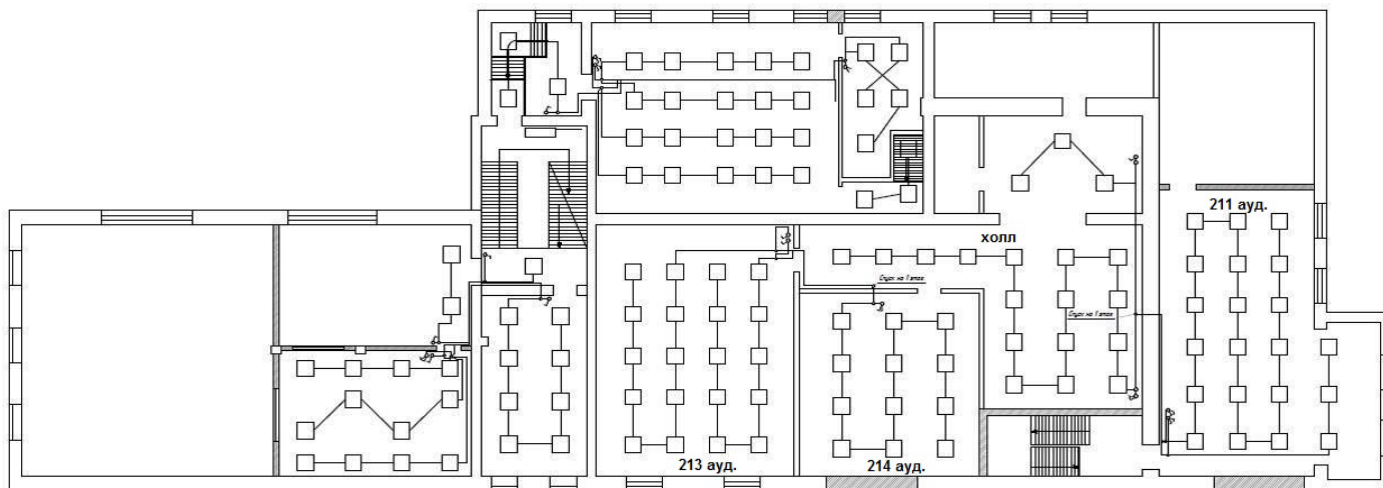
Исполнительный план освещения 2 этажа здания УНЦ ЭИ
